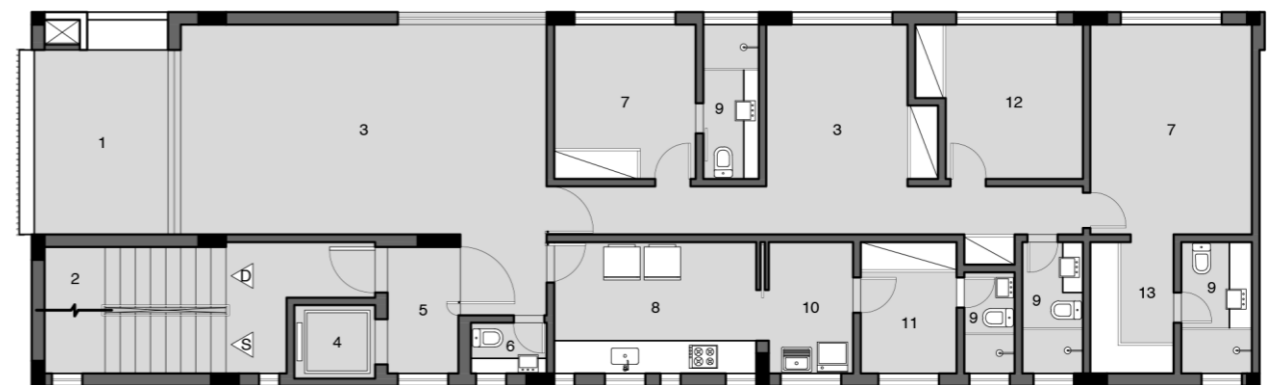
Planta do terceiro pavimento do Residencial Zíder
